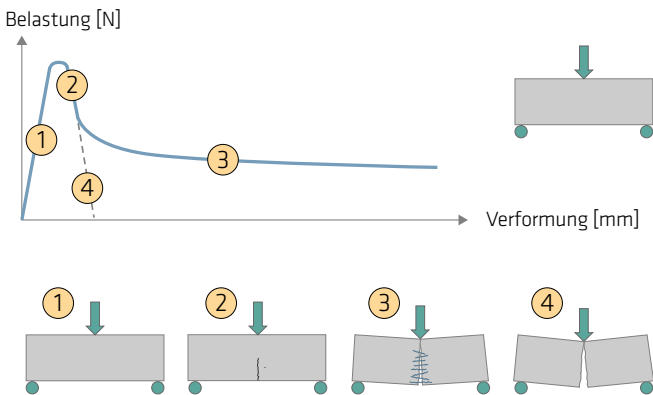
Leistung eines Faserbetonträgers im 3-Punkt-Biegeversuch im Vergleich zu unbewehrtem Beton
